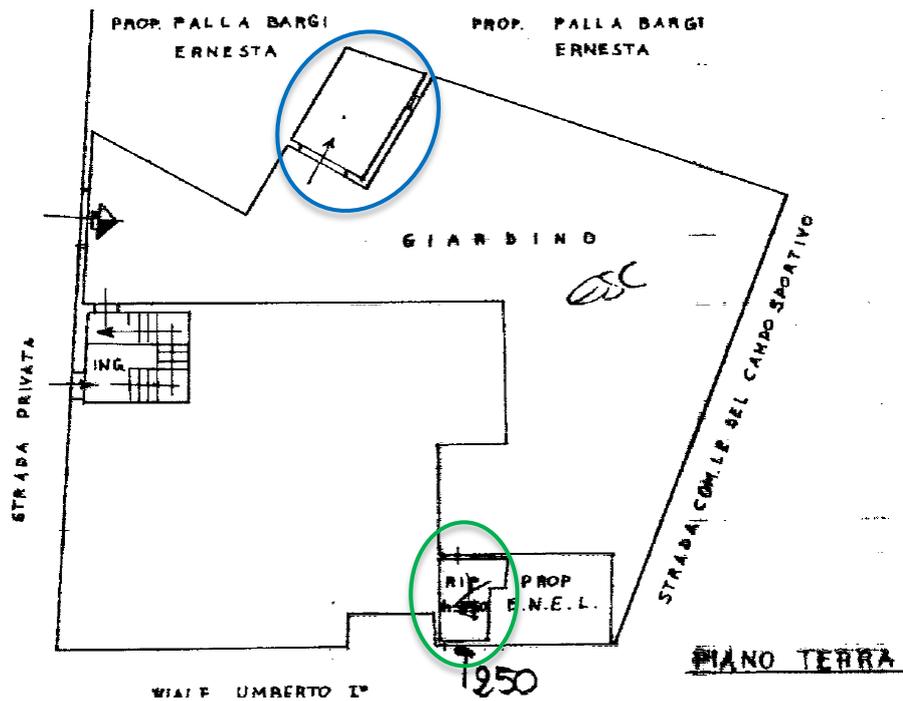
Estratto della planimetria catastale del ripostiglio oggetto di stima
